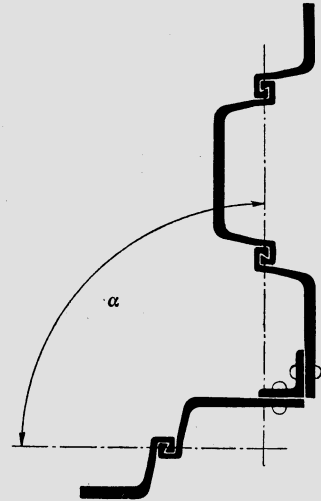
Spundwandanschlüsse und Eckverbindungen. (Eiserne Spundwand, Bauart Larssen.)
